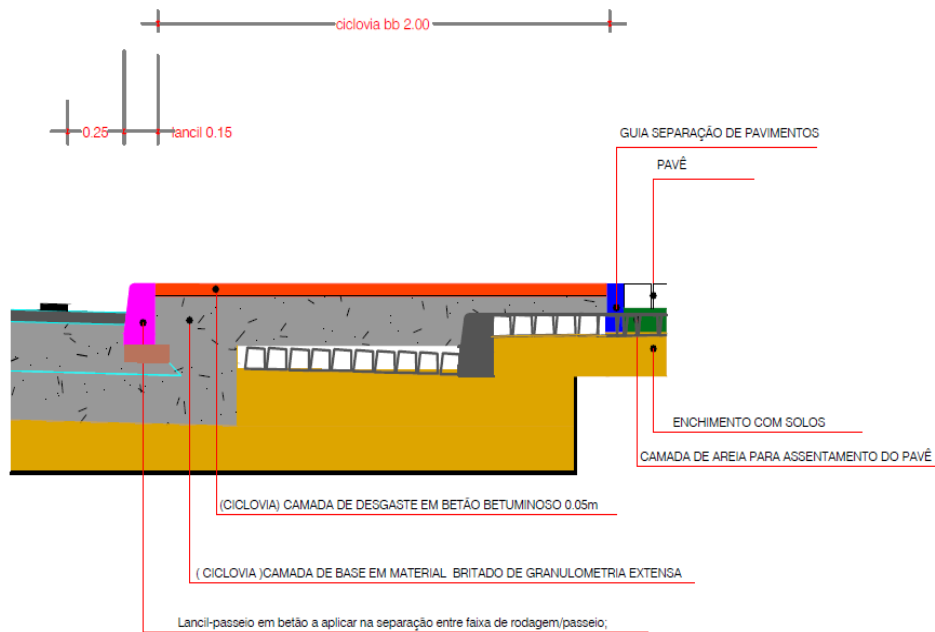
13: Pormenor de corte transversal em zona de passeio [Instituto de Estradas de Cabo Verde, 2015]
